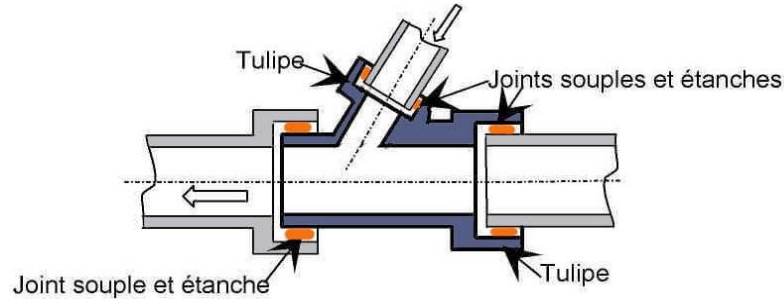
Exemple de culotte en "Y" Male/Femelle/Femelle à 67°30
